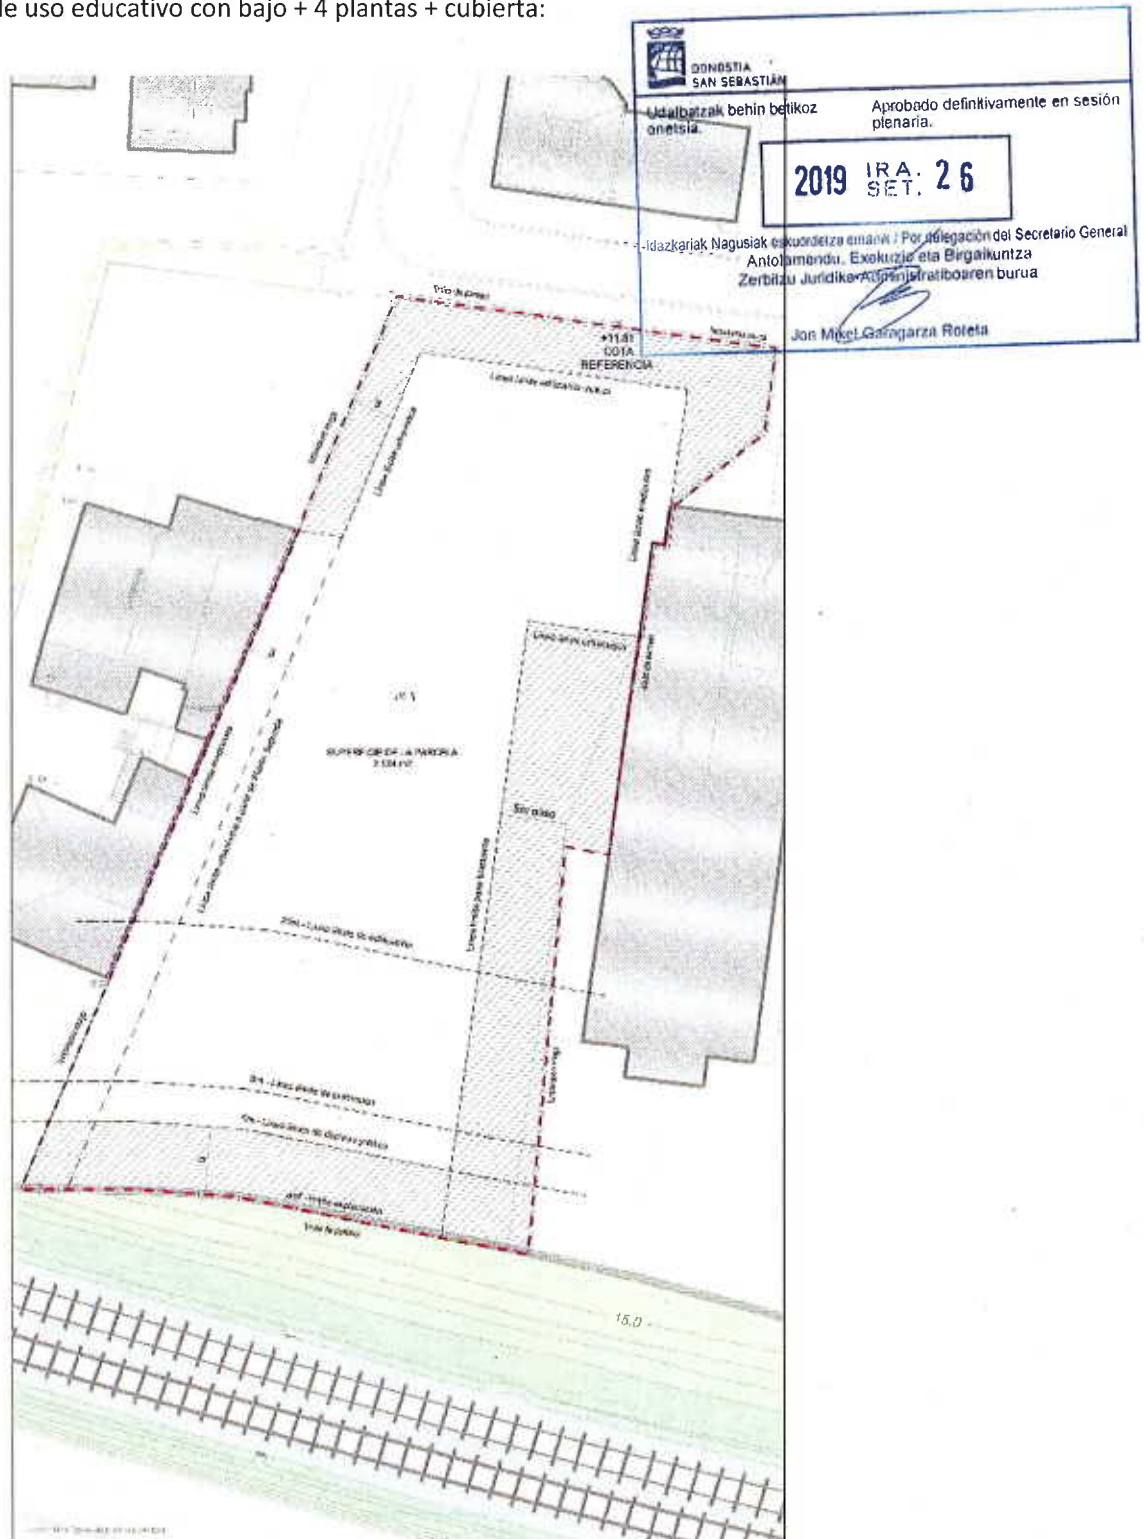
Planta de la situación futura. Información facilitada por el cliente.
